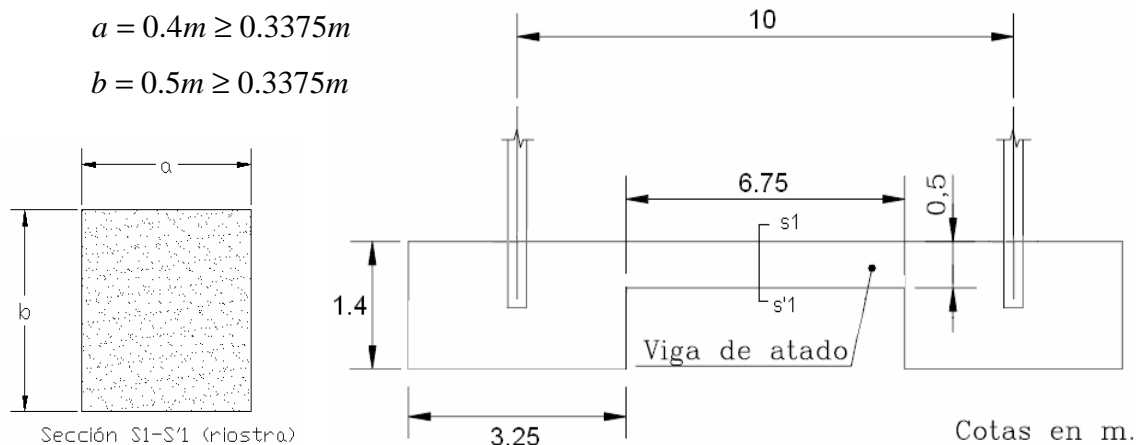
Predimensionamiento riostra (viga atado) de cimentación
